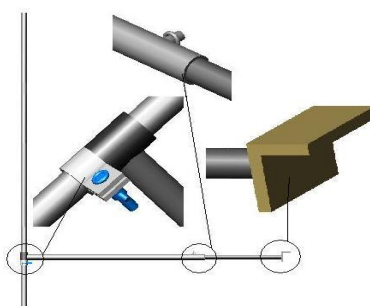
Compasso metálico para assentamento de tijolos em construção circular.
